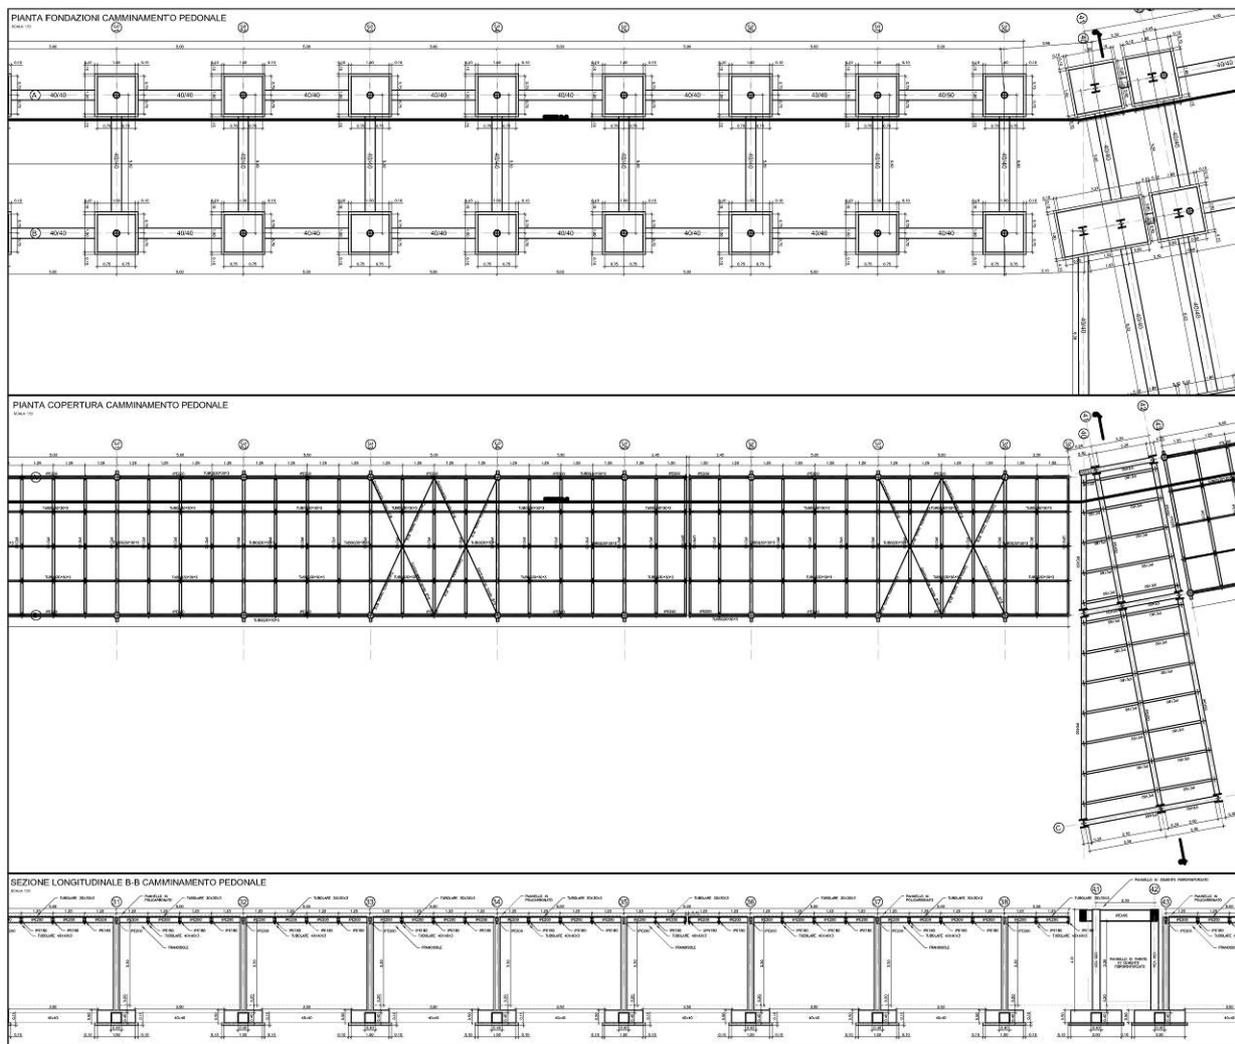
Pianta fondazioni, copertura e sezione longitudinale del camminamento pedonale
